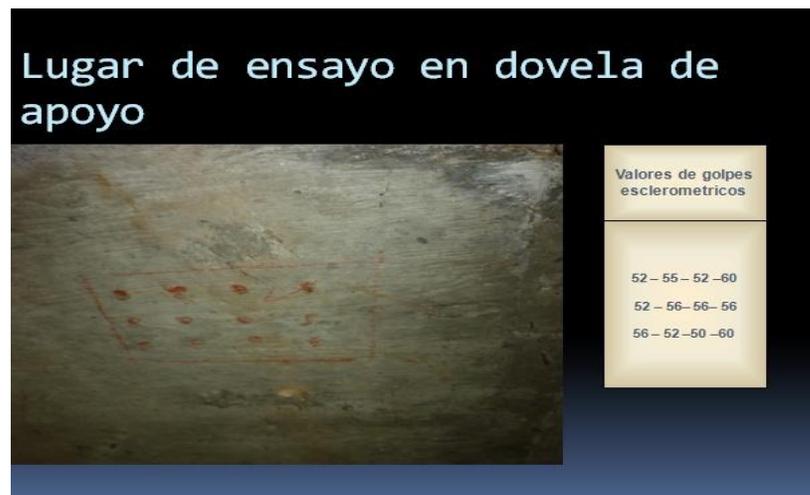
Ensayo del esclerómetro en dovela de apoyo acceso norte en zona
